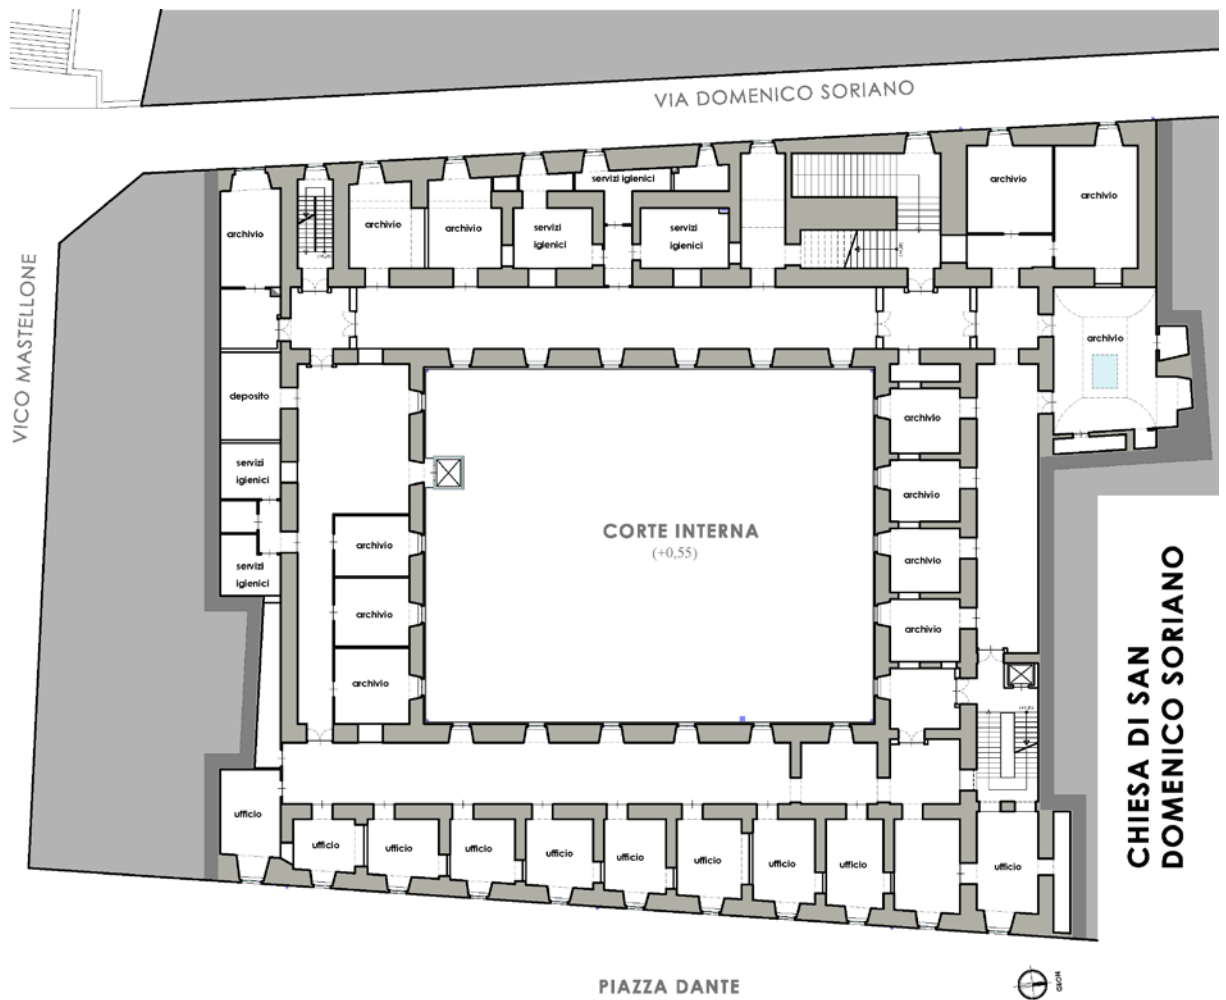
Indicazioni progettuali: Pianta Piano Primo
